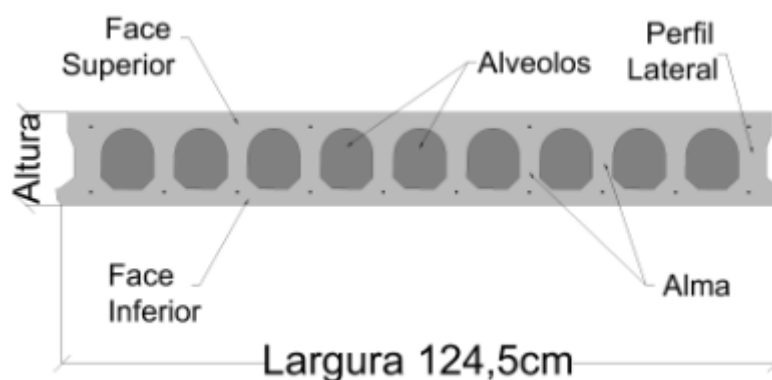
Seção transversal típica de laje alveolar (Puma Lajes Alveolares, 2018).
